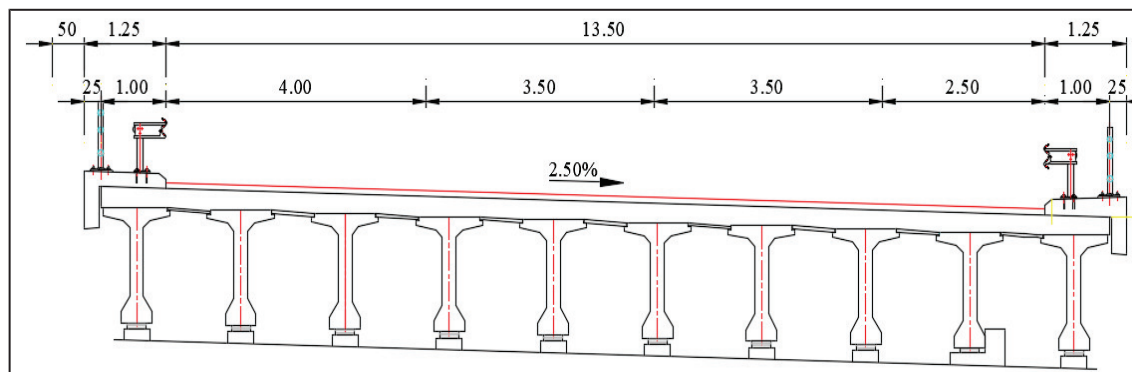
La coupe transversale de la variante Ponts à poutres préfabriquées précontraintes par post-tension.
